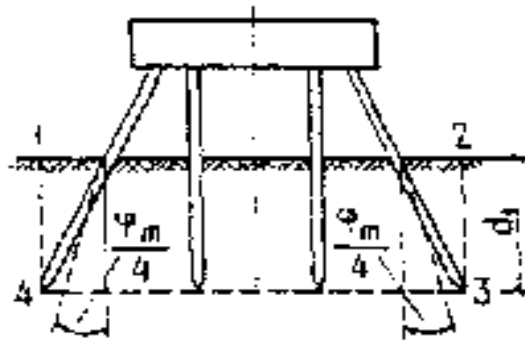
Условный свайный фундамент с ростверком, расположенным над грунтом при угле наклона свай более  $\varphi_m/4$
